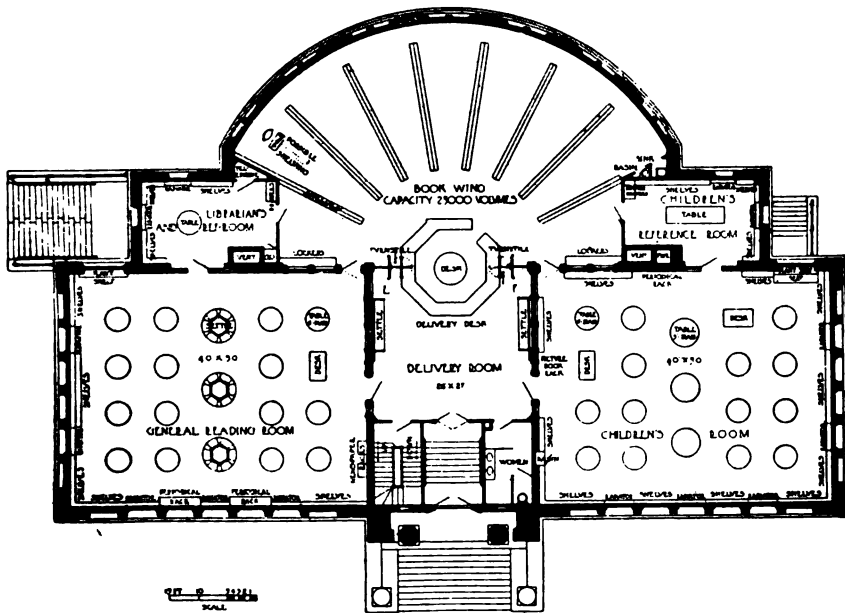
Rez-de-chaussée de la (East Liberty Branch) Pittsburg
